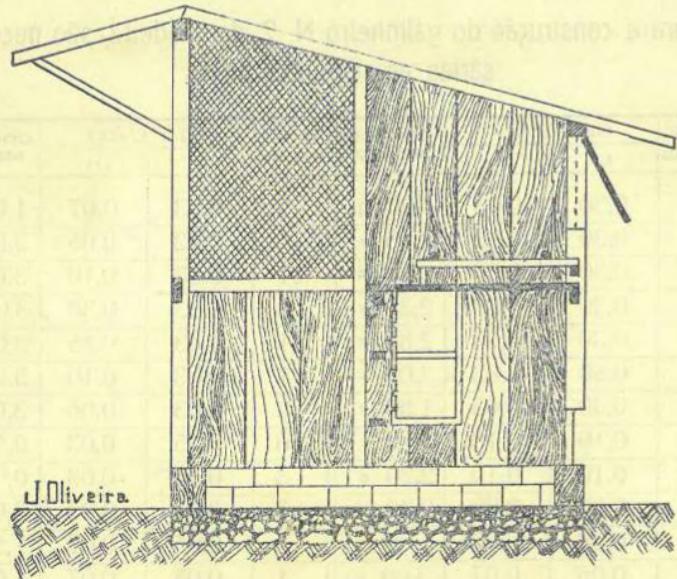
Planta do galinheiro nº. 2, tendo no verso o material que se fará necessário para a sua construção de madeira ou de alvenaria de tijolo.
